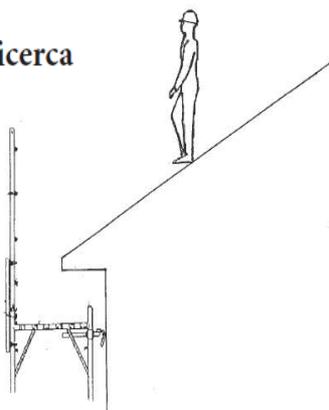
Parapetto di sommità [Fab-015]
